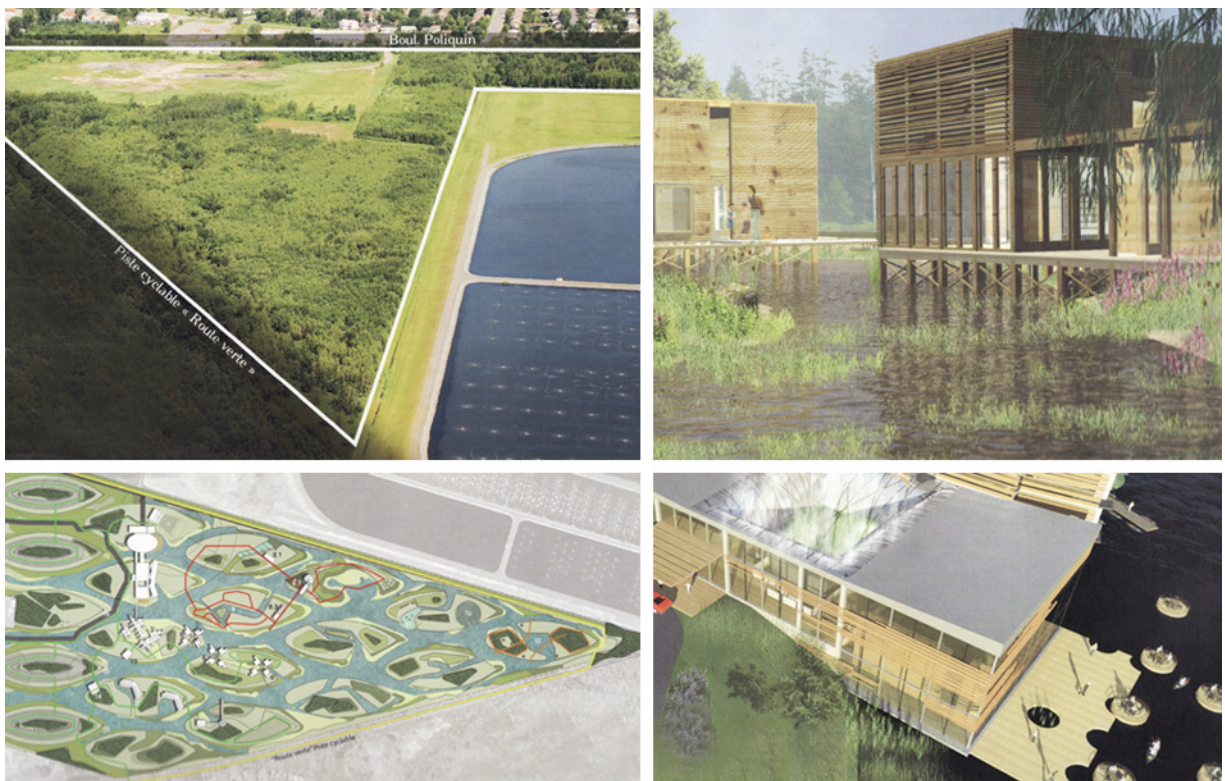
Site original, plan d'implantation et illustrations du projet Écomonde. Modifié de Thérault, et Pélouquin (2008).
